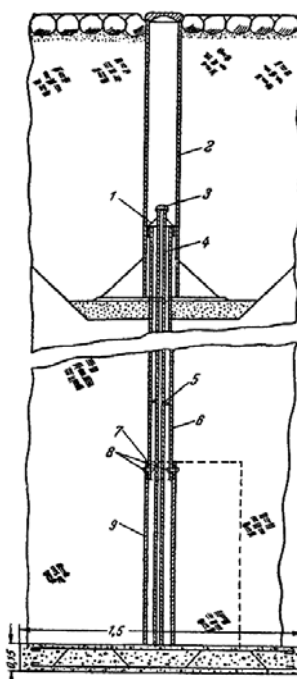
Глубинная плита-марка: 1 — центрирующая крышка; 2 — труба $d = 21,25$ мм, $l = 1500$ мм; 3 — марка; 4 — труба $d = 25,4$ мм (штанга репера); 5 — направляющий диск; 6 — труба $d = 101,6$ мм (длина по месту); 7 — вкладное кольцо из листовой стали; 8 — свинцовые заклепки, 4 шт., $d = 12$ мм; 9 — труба $d = 228,6$ мм
